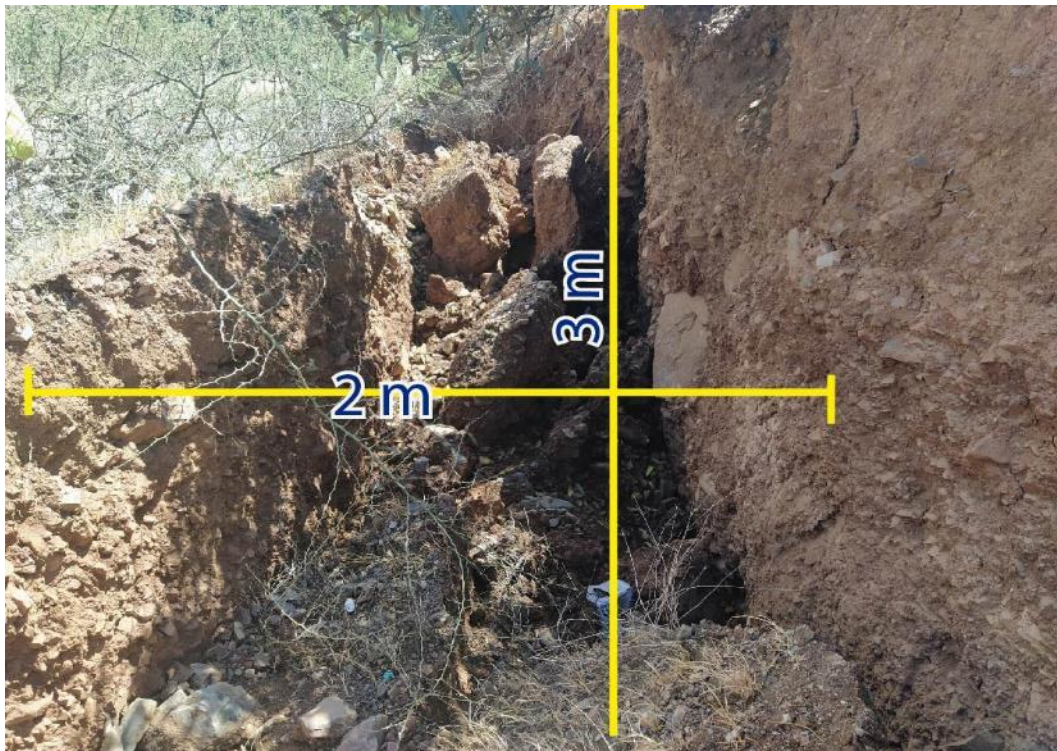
Grietas tensionales de 2 m de ancho, y 3 m, de profundidad, donde se observa el arroj de basura.
